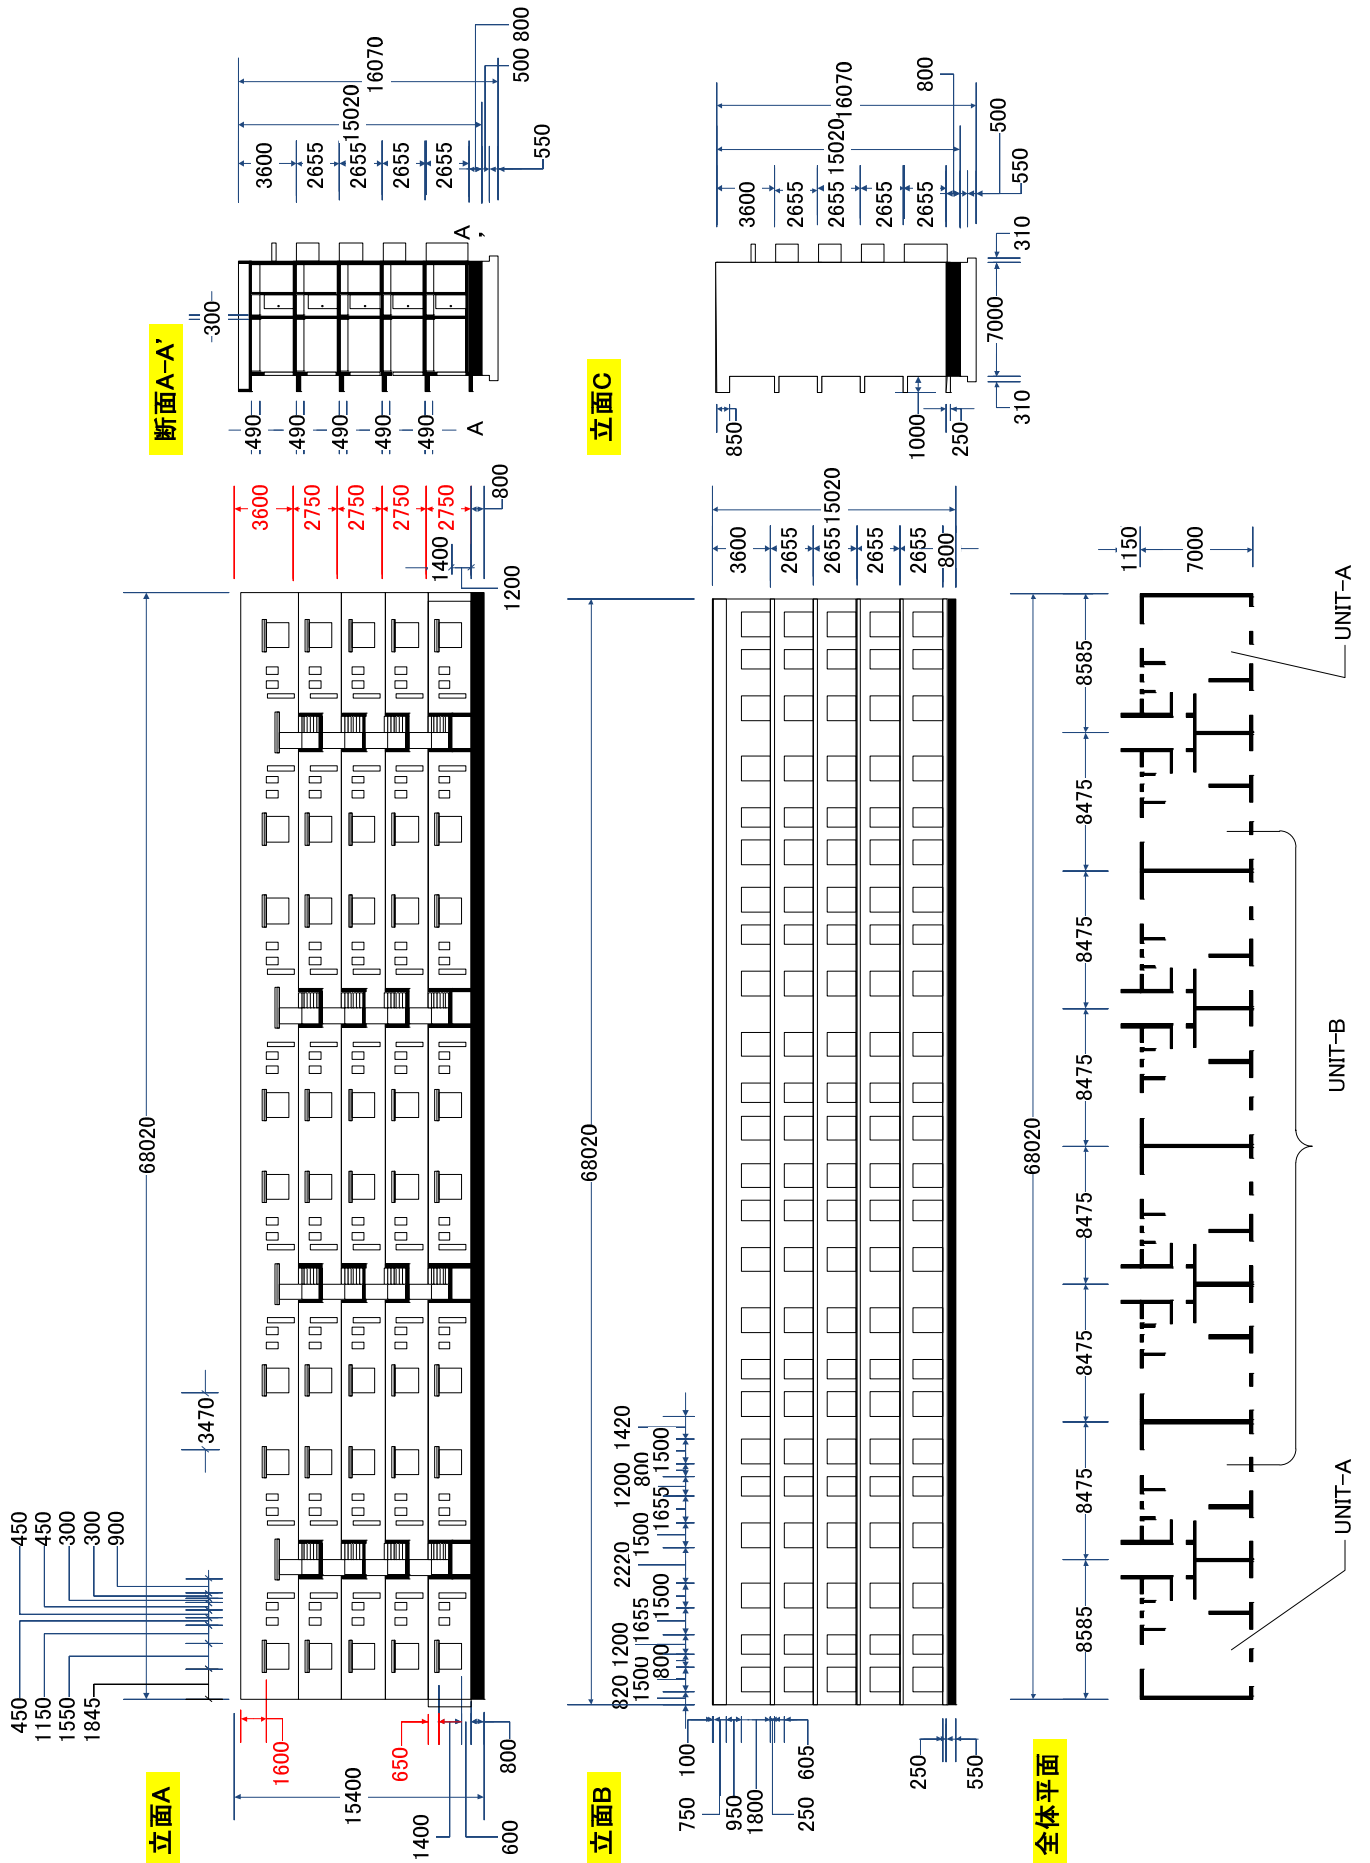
雇用促進住宅陸前高田第2 宿舍の立面図・平面図 (単位: mm)
